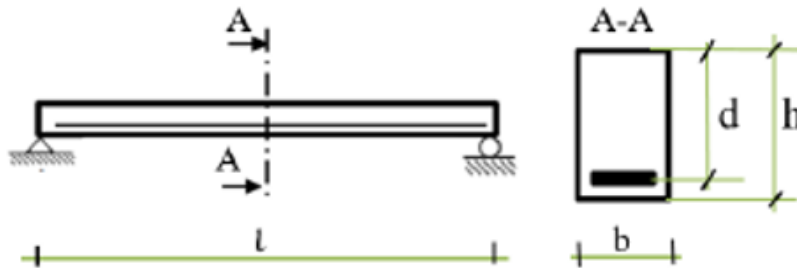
Section droite d'une poutre rectangulaire en BA [12]
